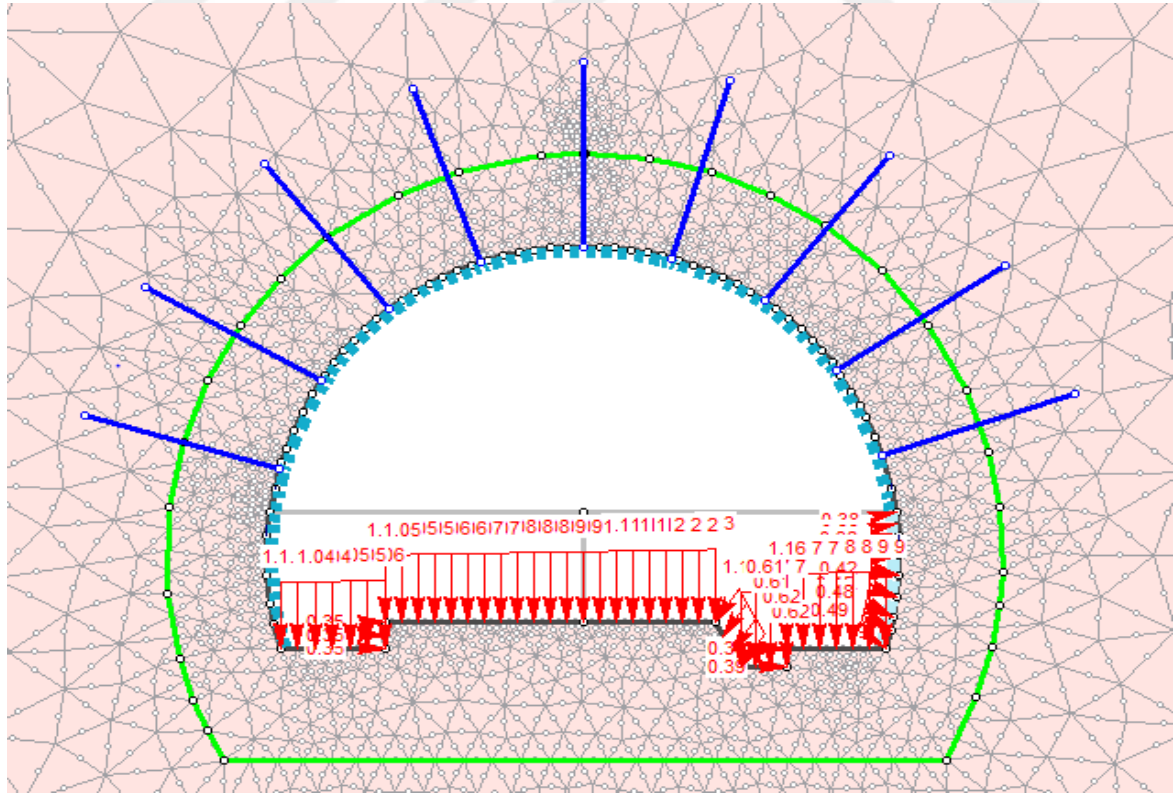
Aşama-2-3-4-5 üst yarının kazılması
